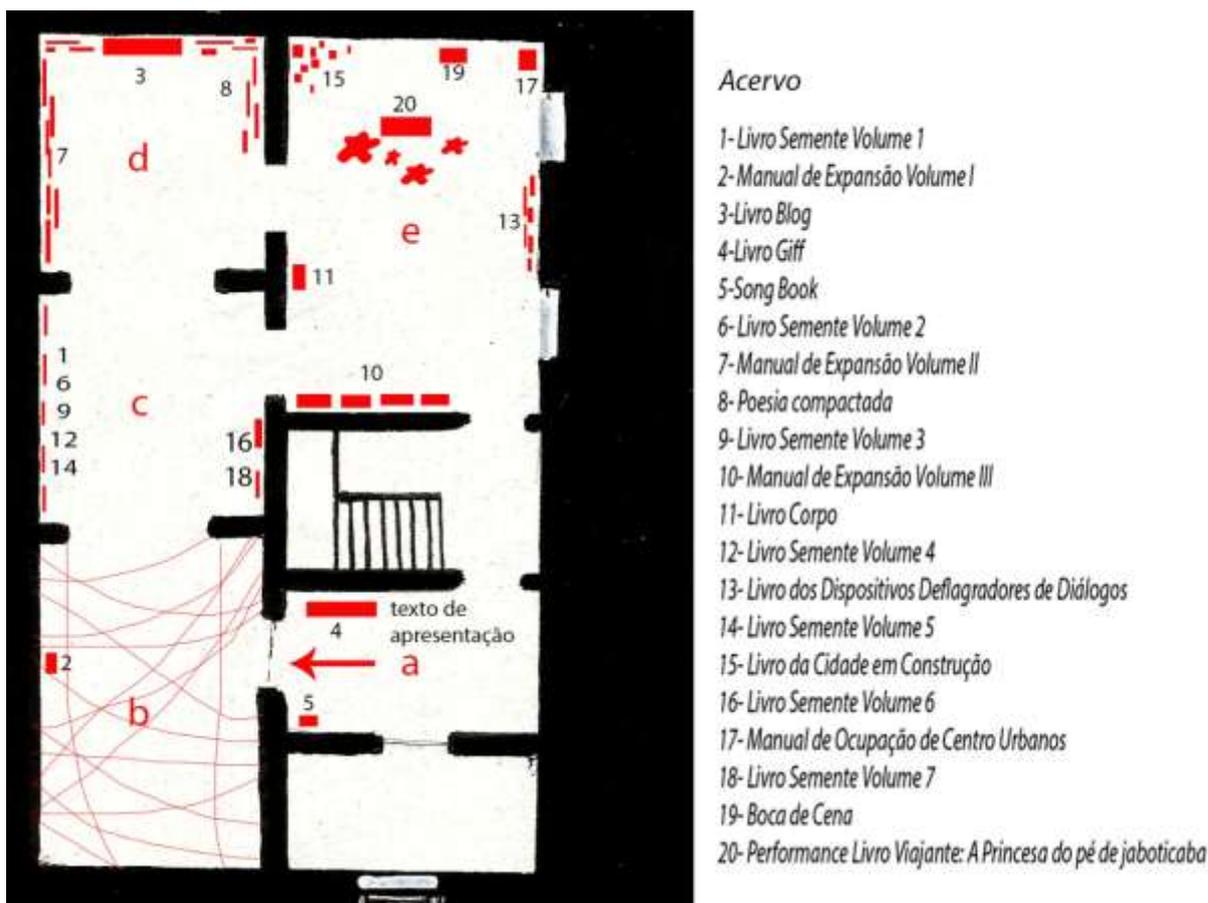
Planta baixa da Galeria. Parte do Livro Doutorado Muquequinha. Acervo pessoal.
